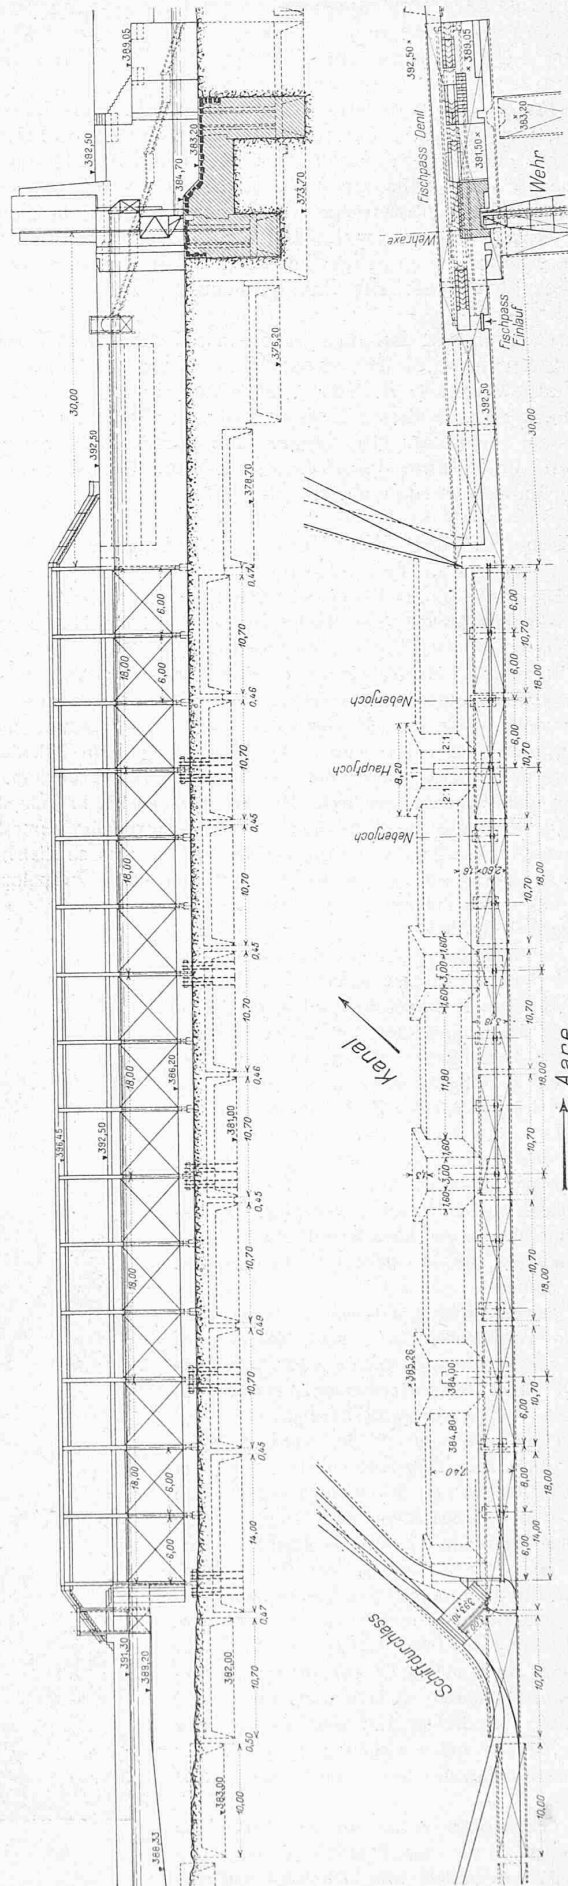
und 39. Grundriss und Aufriss des Kanal-Einlaufbauwerks, rechts Schnitt durch Öffnung 5 („Grundablass“) des Stauwehrs (vergl. Abb. 8 und 9 auf Seite 11 dieses Bandes). — Masstab 1 : 600.
